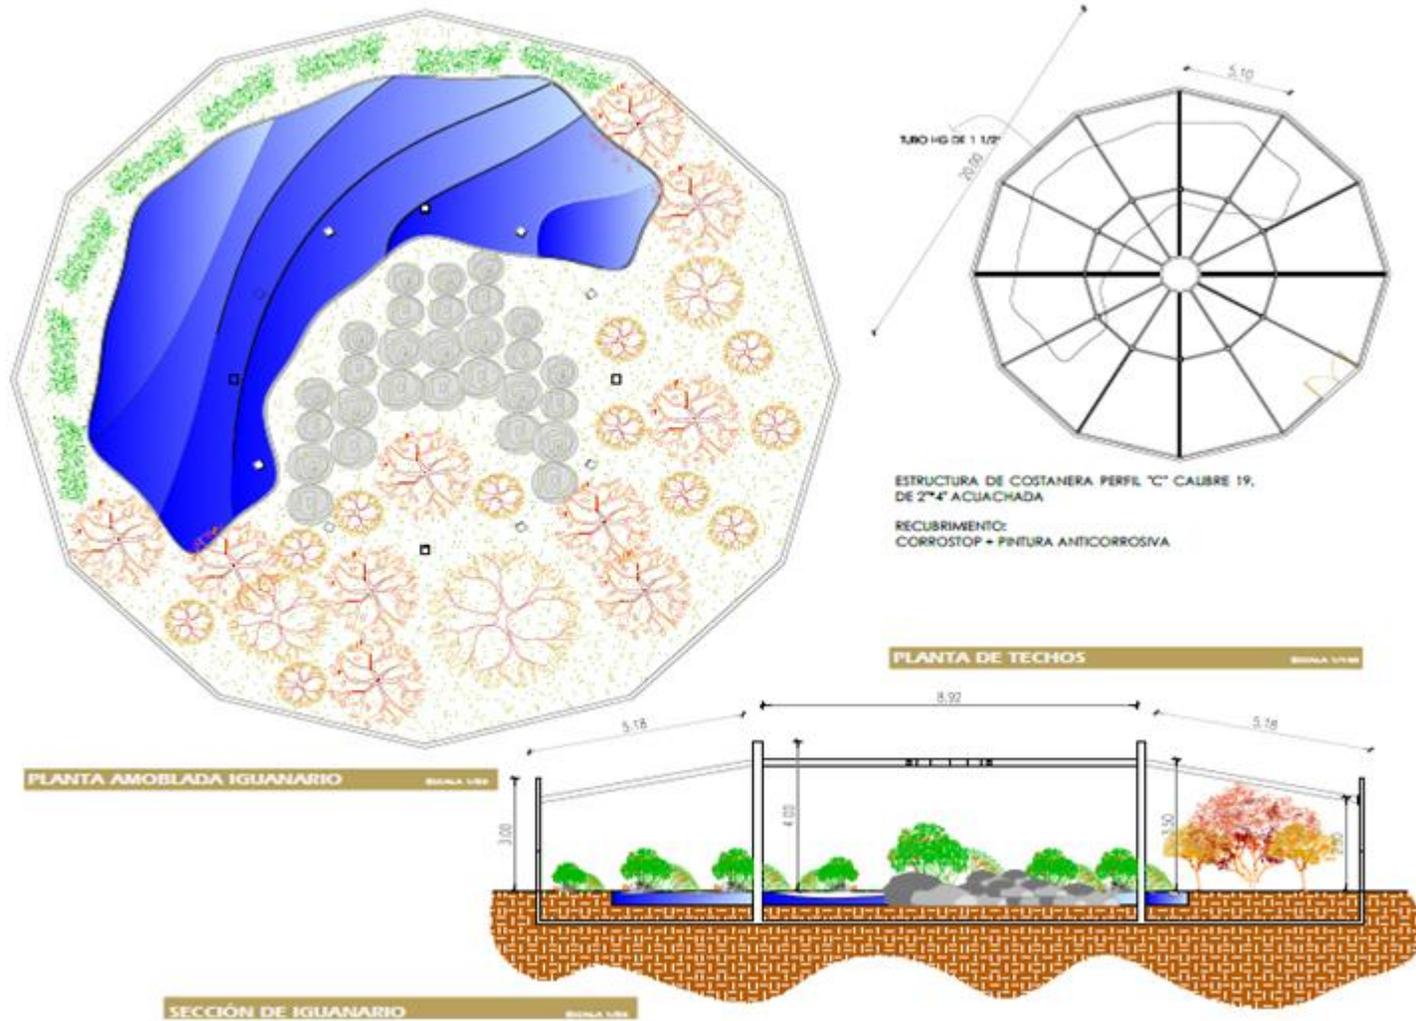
Diseño arquitectónico de la nueva estructura propuesta.
